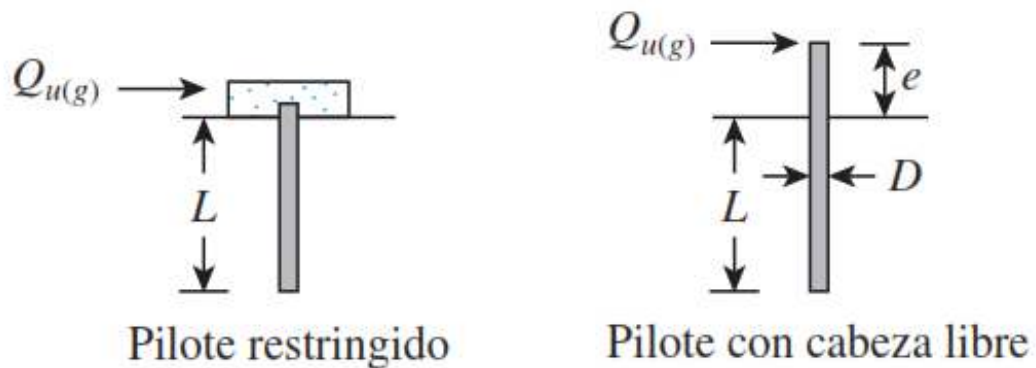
Pilotes restringido - Pilotes con cabeza libre.
